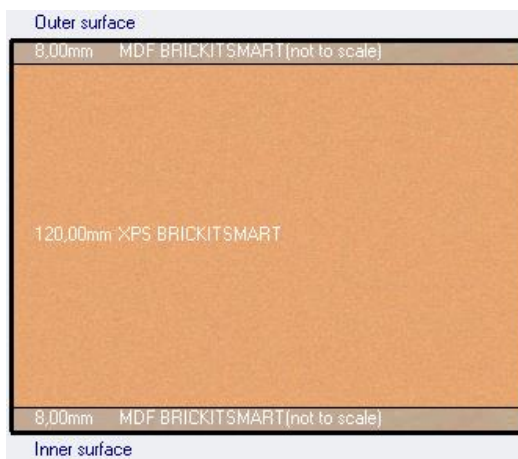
Camadas do sistema construtivo BRICKITSMART
